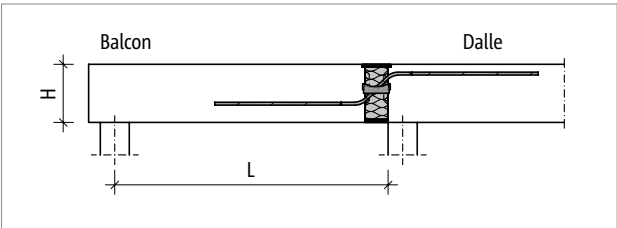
Schöck Isokorb® T Type Q-E-V : Système statique
